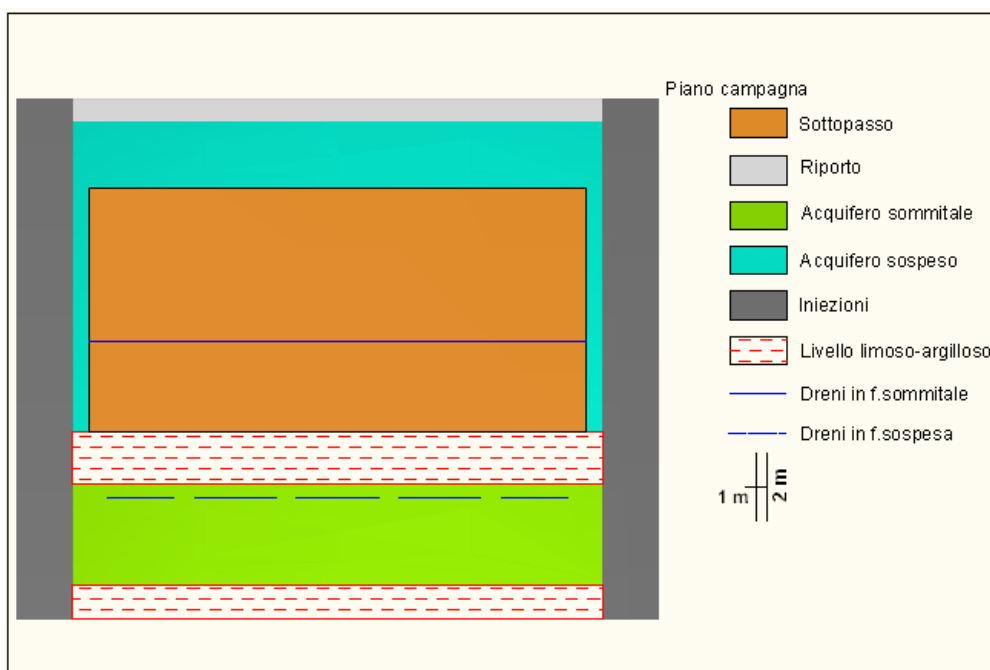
Vista in sezione del sistema di iniezioni e degli interventi di drenaggio.
